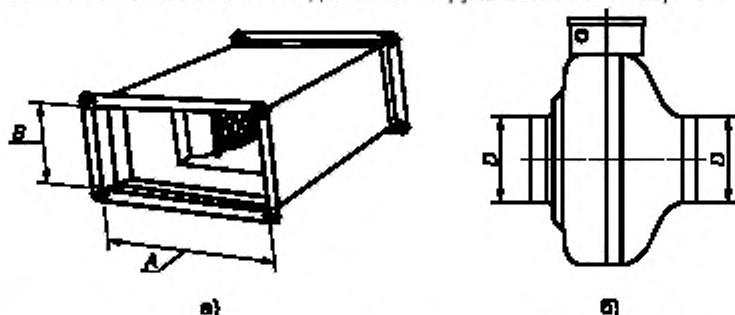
Вентиляторы канальные с прямоугольными [а)] и круглыми [б)] входными и выходными фланцами
